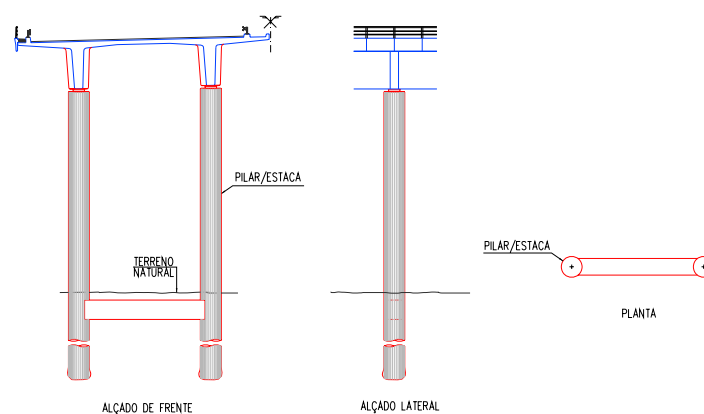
Alçados e secção transversal dos pilares do viaduto de acesso.
